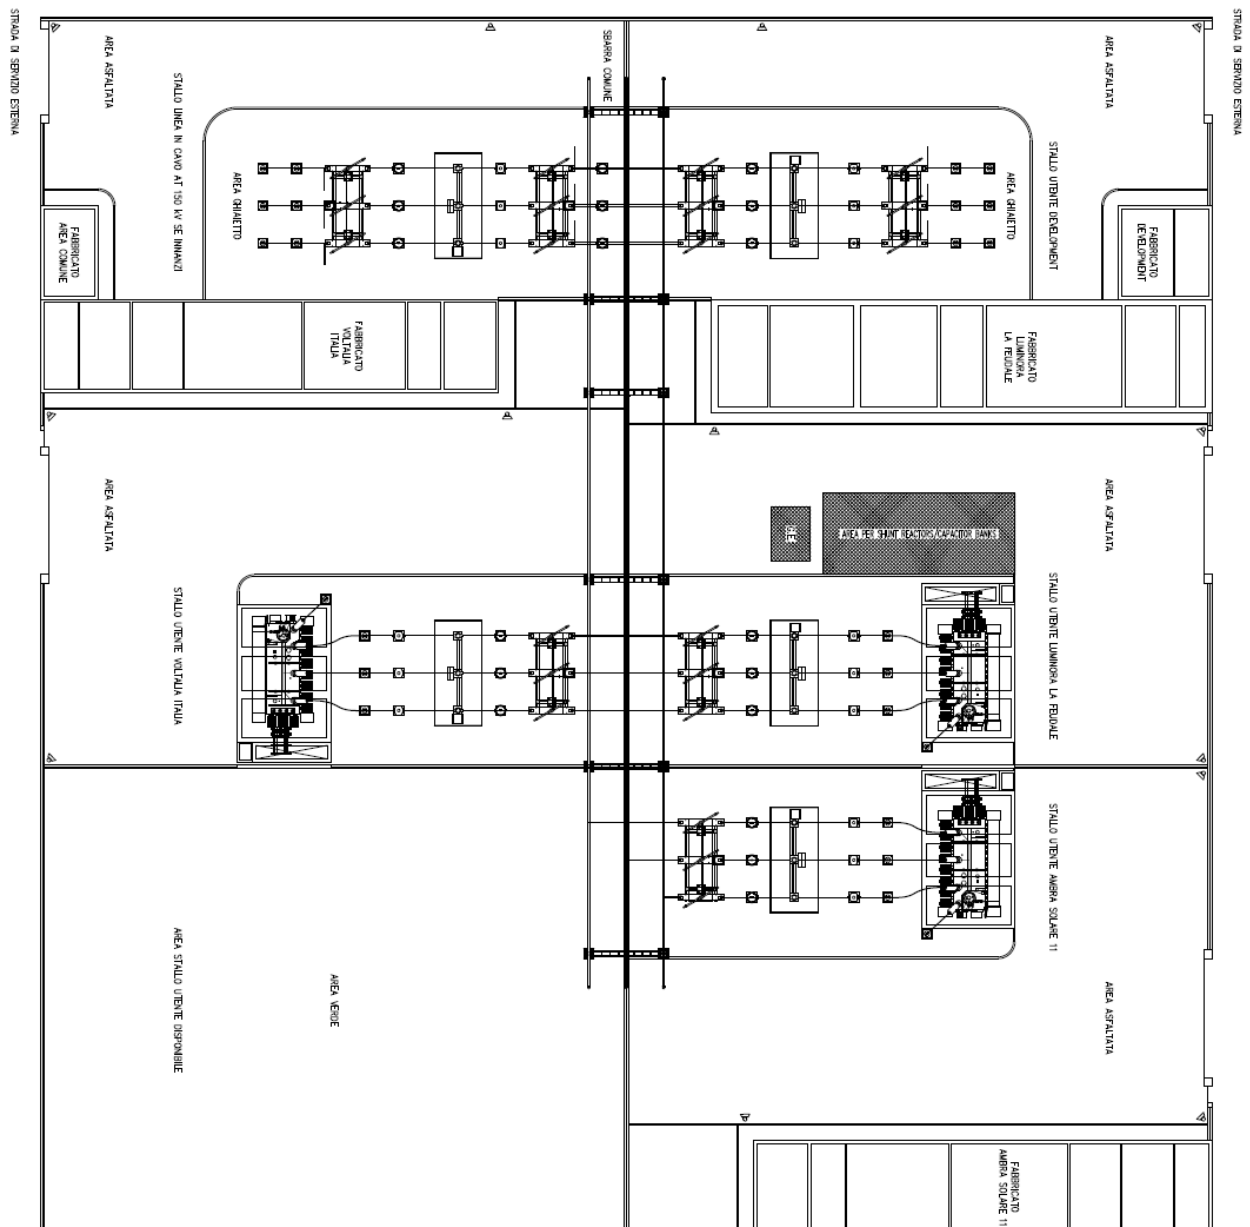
Planimetria elettromeccanica della sottostazione multiutente 20/150 kV
